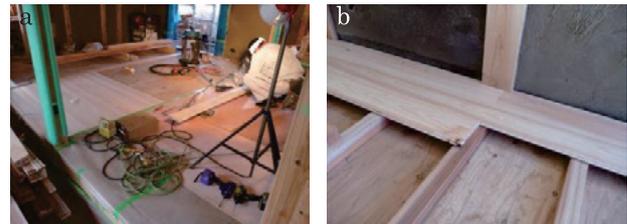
a: 1階床の施工状況、b: 2階床の配線用スペース
